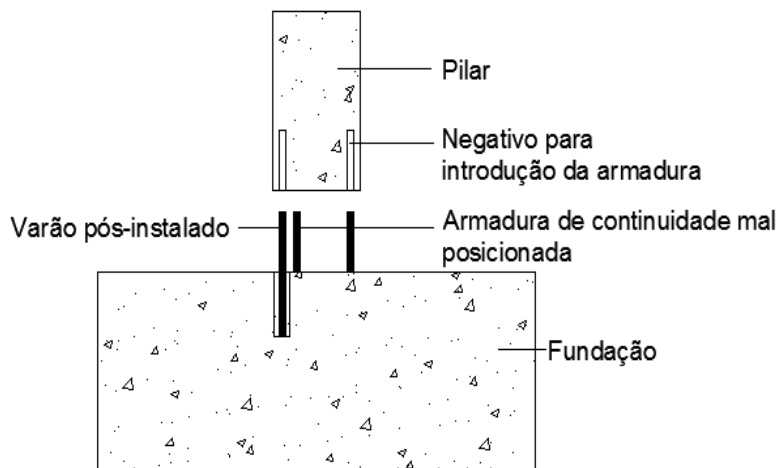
Exemplo de um pilar pré-fabricado com a armadura mal posicionada
